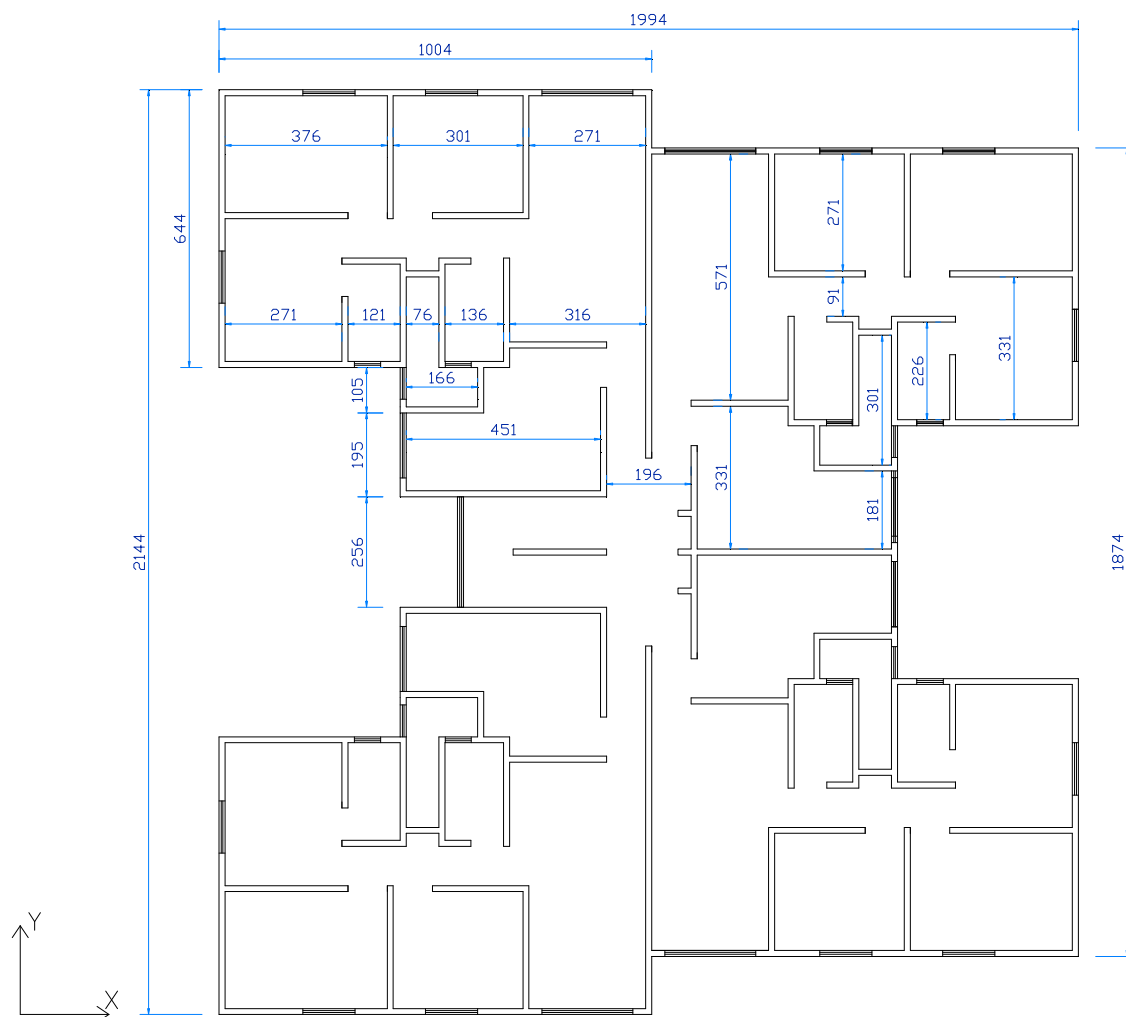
Arranjo arquitetônico do pavimento tipo do edifício Jardim Portugal (dimensões em cm).
